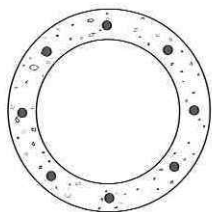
Pilote de hormigón pretensado tipo Raymond
